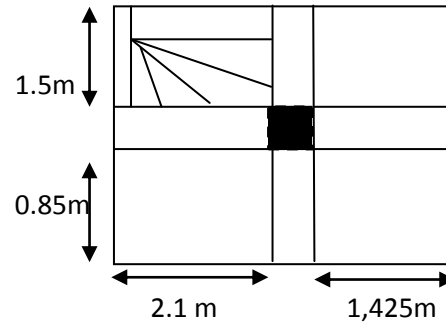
Surface afférente du poteau de la cage d'escalier.
